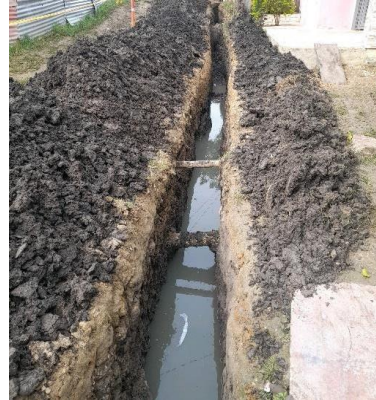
Aguas servidas estancadas en zanjas excavadas del callejón #2, sector las flores.
